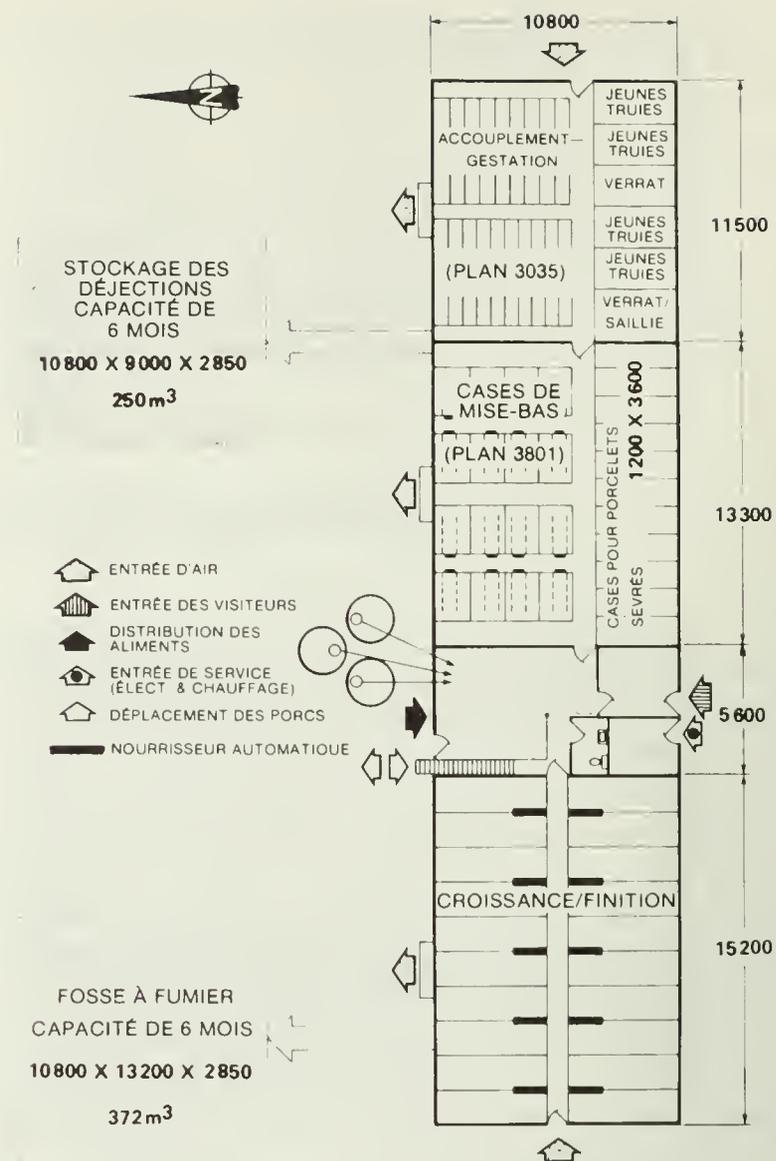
Plan rectangulaire, porcherie de mise bas et d'engraissement mise bas continue, troupeau de 50 truies
